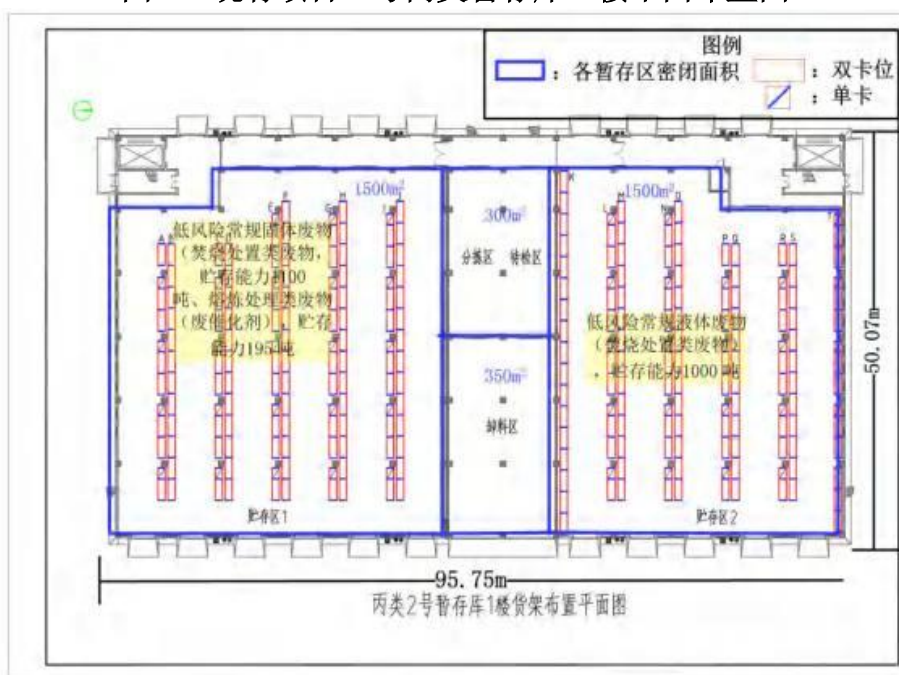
现有项目 2 号丙类暂存库 1 楼平面布置图
